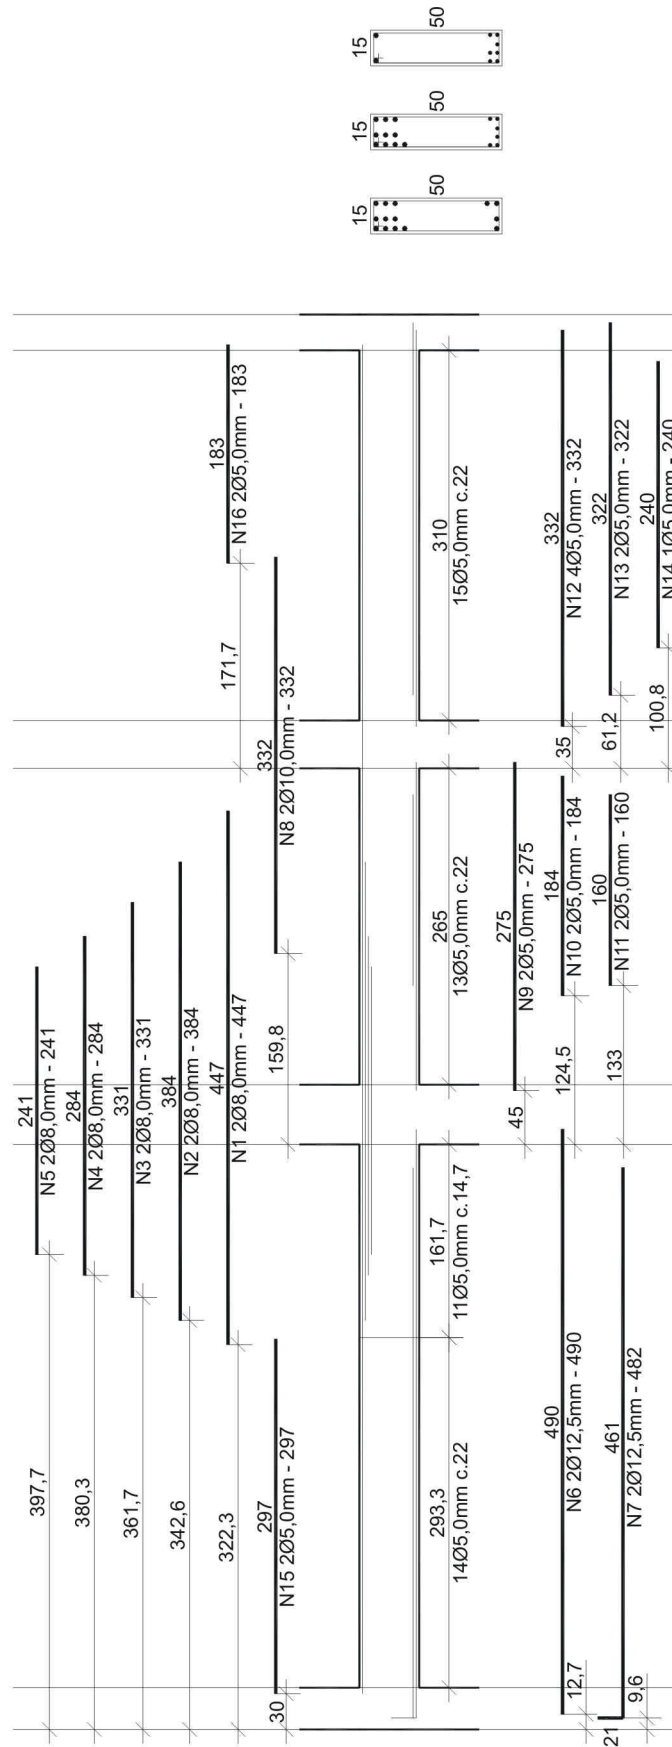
Detalhamento Viga 04.10, realizado pelo VigaCalc.
